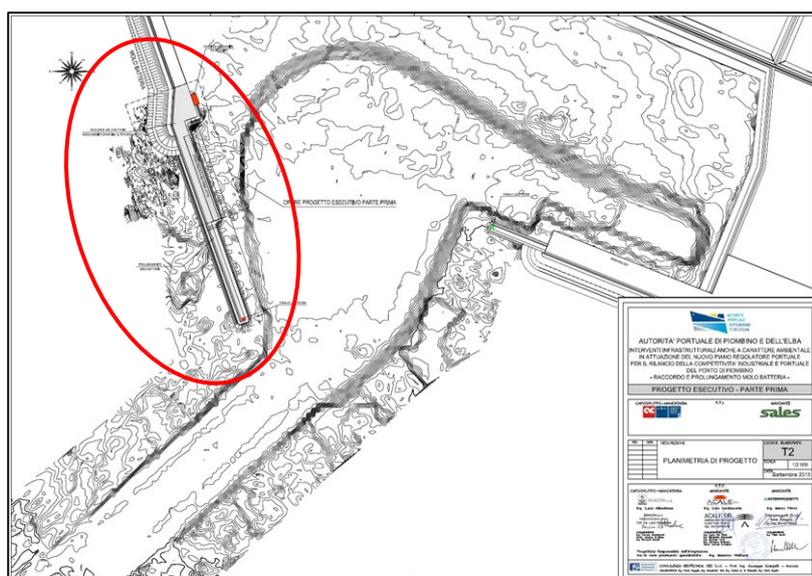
Raccordo e Prolungamento molo Batteria (planimetria)
